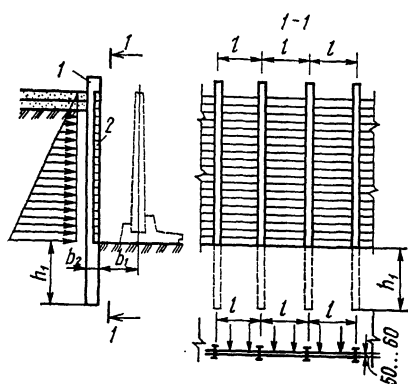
Временное крепление вертикальных стенок котлована с помощью металлических свай
